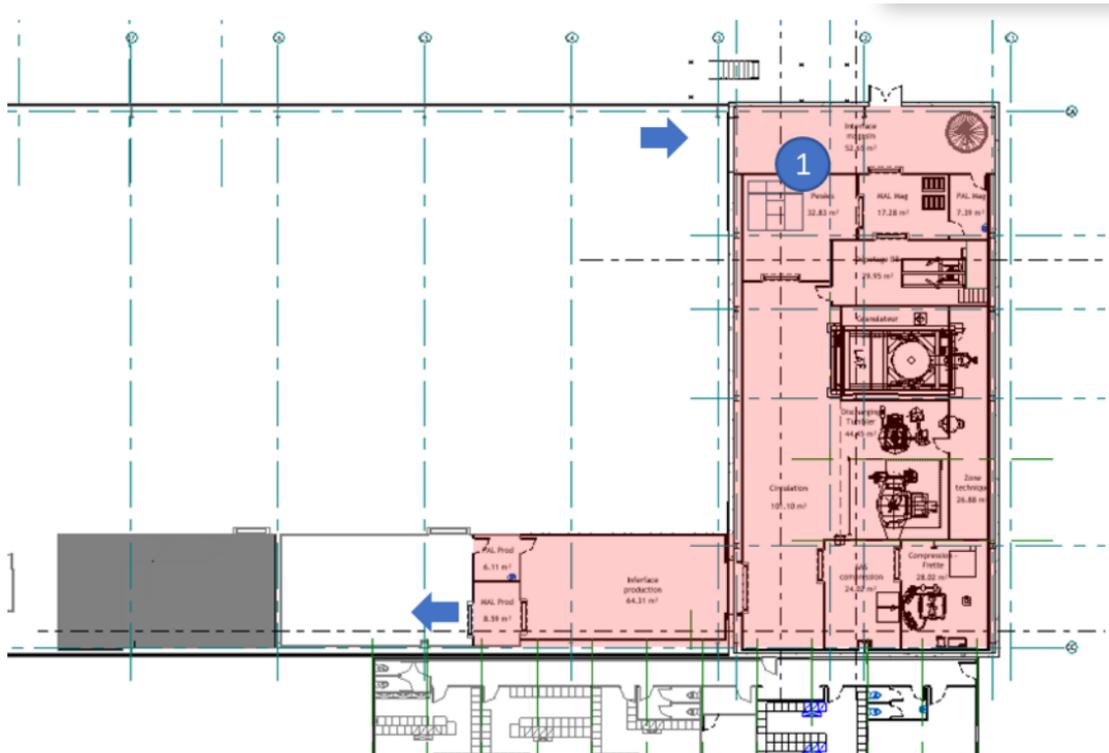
Plan d'implantation du nouvel atelier en rez-de-chaussée
